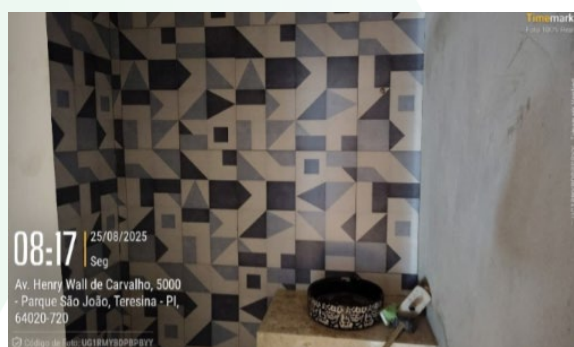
Execução de revestimento cerâmico nas paredes do banheiro.
